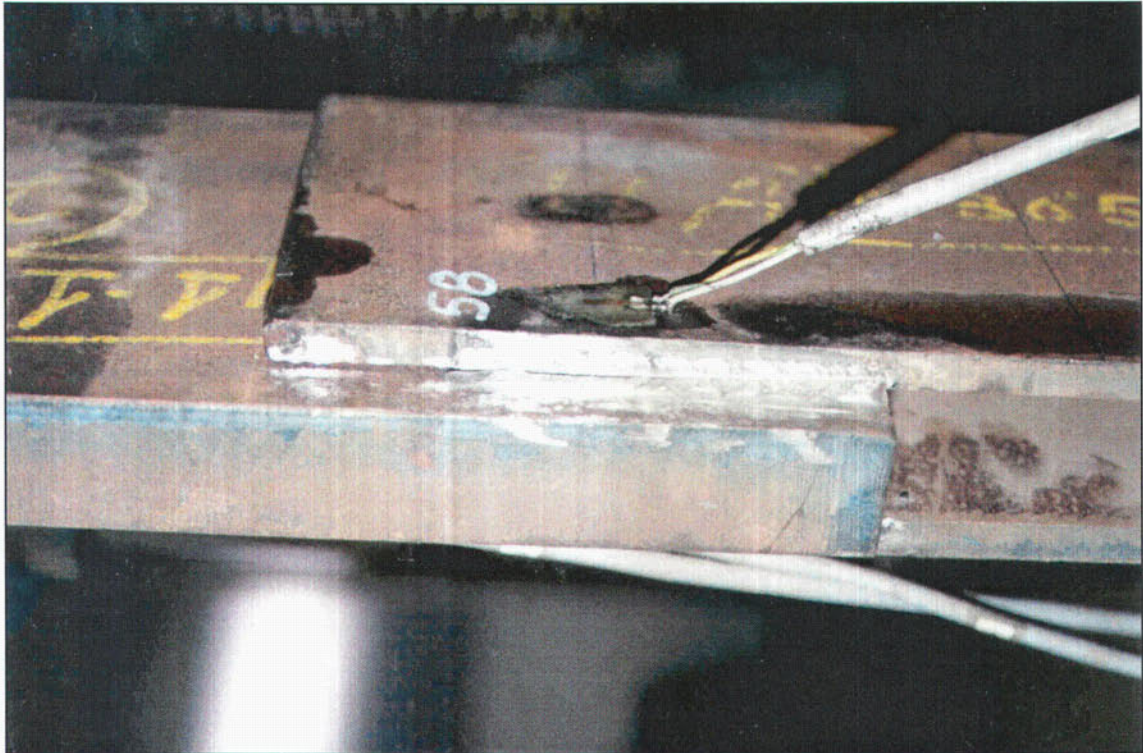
Nuevo detalle de rotura de soldadura en la probeta 2T, con la ubicación de una galga extensiométrica.
